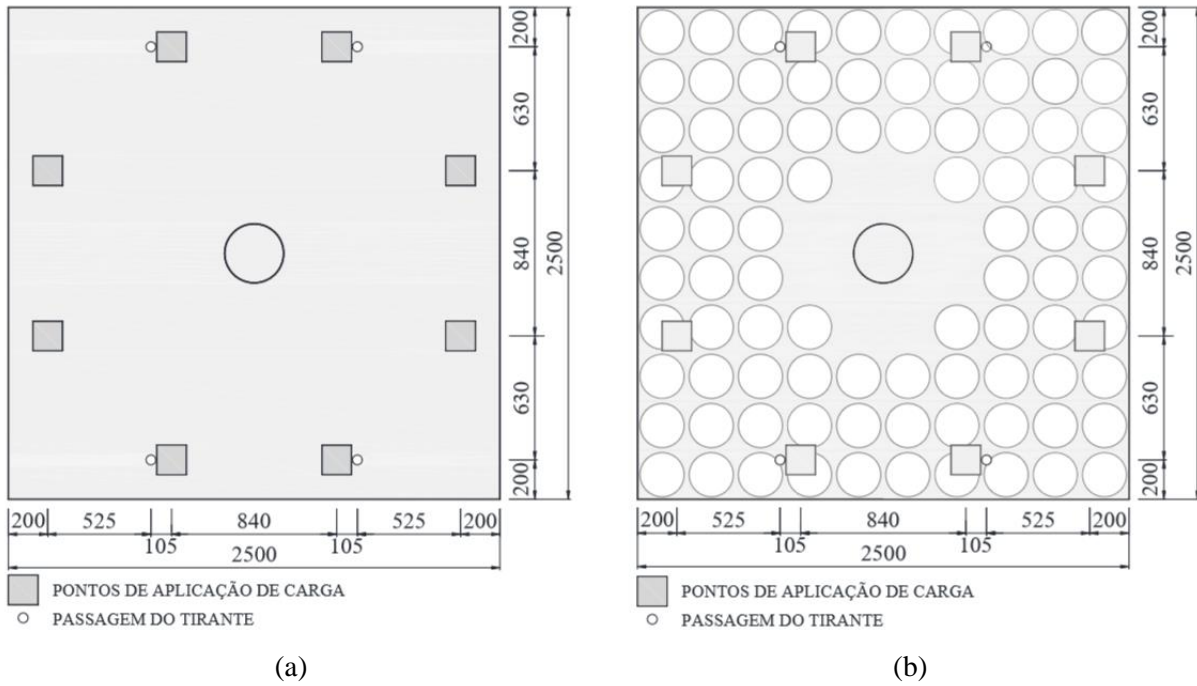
Lajes ensaiadas por NICÁCIO (2018) - (a) RSP28 (b) BD28-P1.
